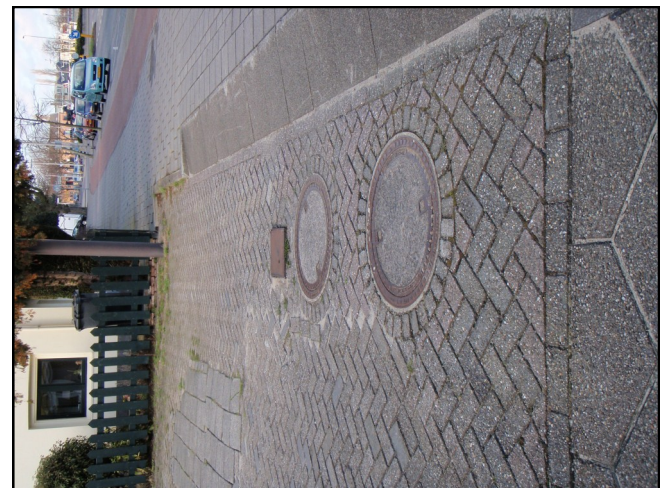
Detailopname verzakking rondom gesaneerde tanks, OWS nog aanwezig.
